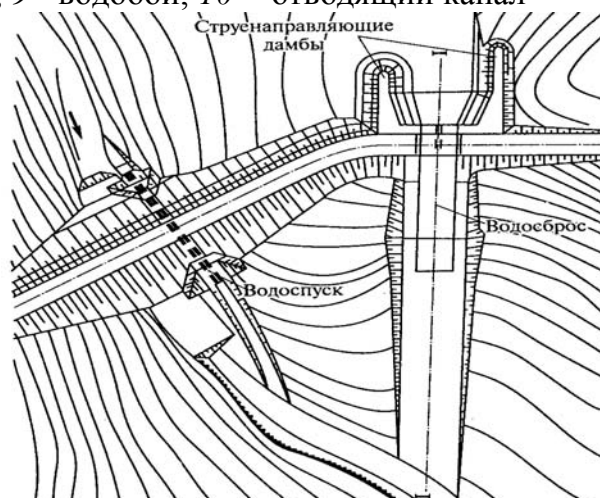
Гидроузел с грунтовой плотиной, береговым регулируемым открытым водосбросом и водоспуском на одном берегу
